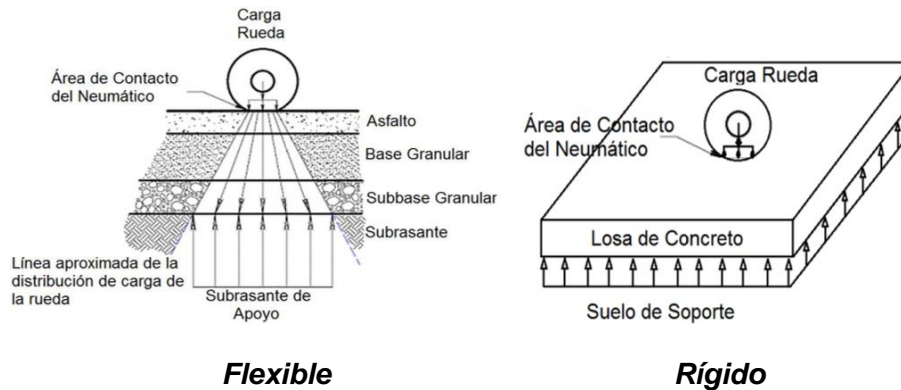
Estructura y distribución típica de esfuerzos del pavimento flexible y rígido.
